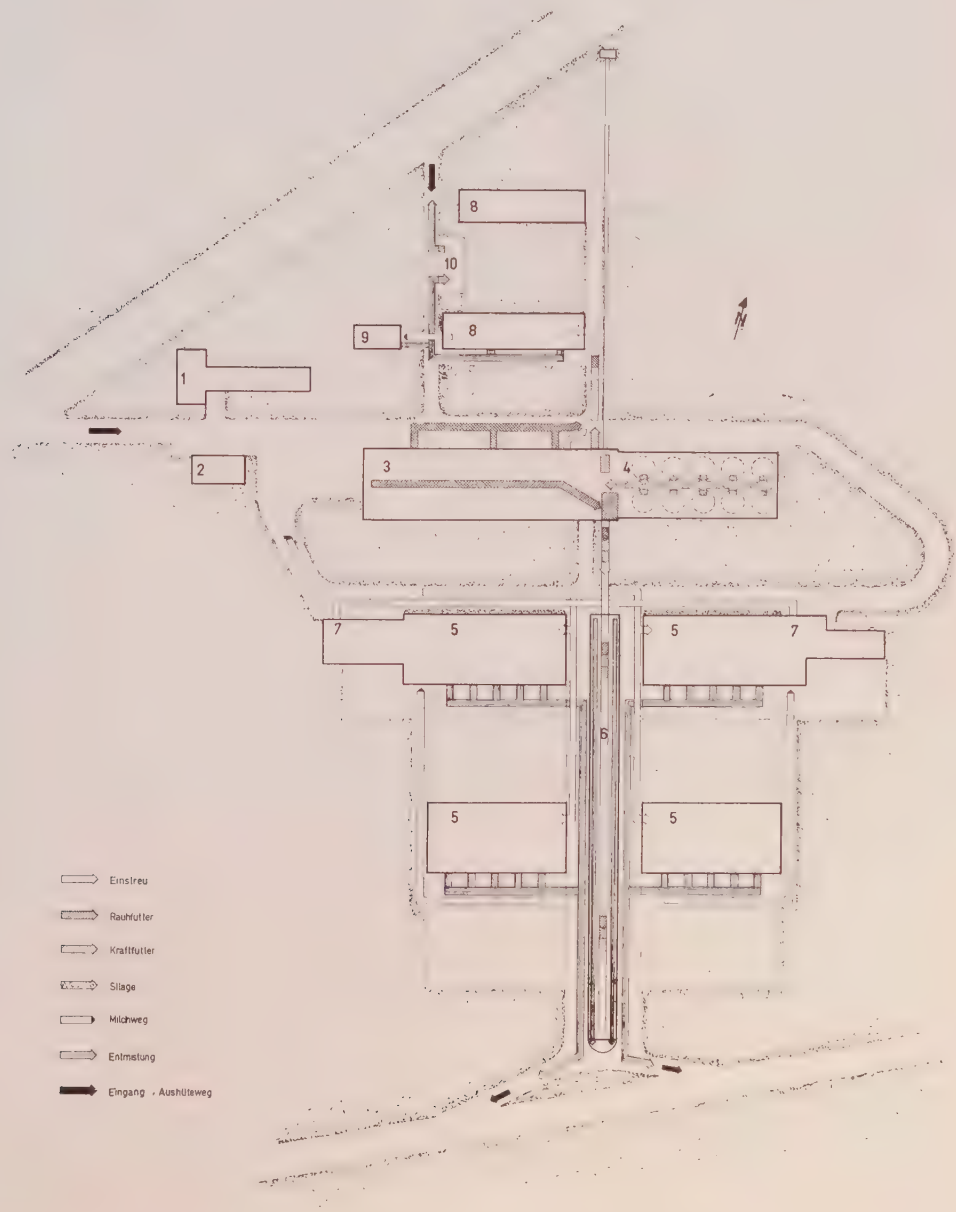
Lageplan mit Ablaufschema 1:1500
